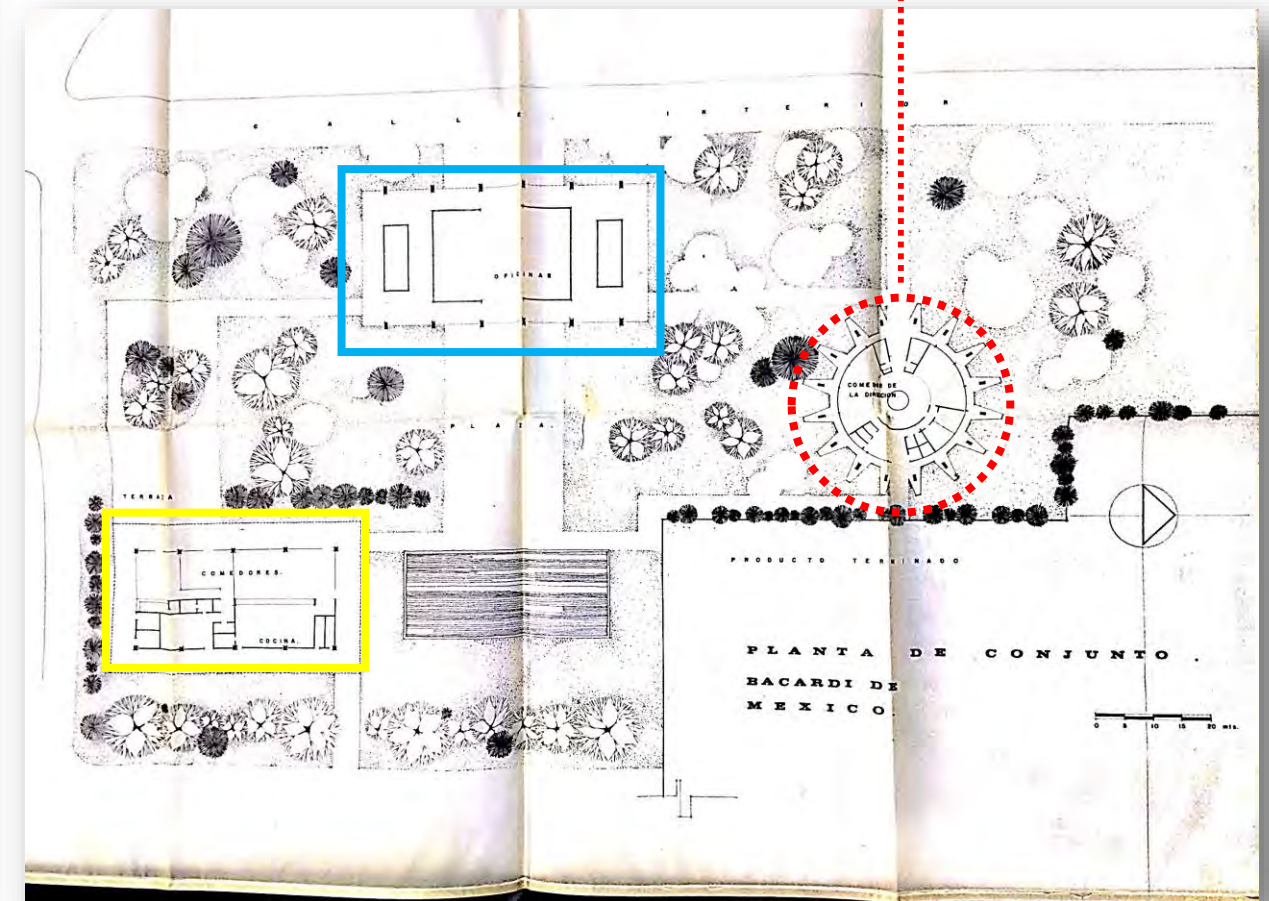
Planta de conjunto Proyecto de Comedor Ejecutivo Bacardí Arq. Enrique de la Mora y Palomar
